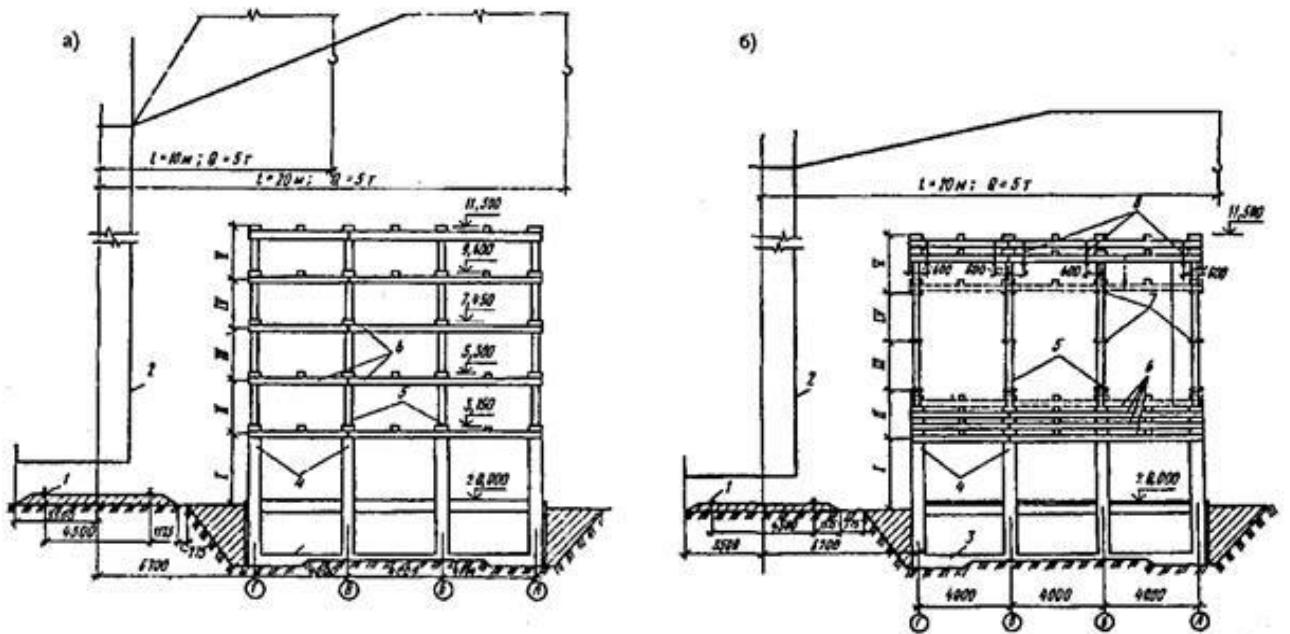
Монтаж типовой сборной железобетонной вентиляторной градирни:
